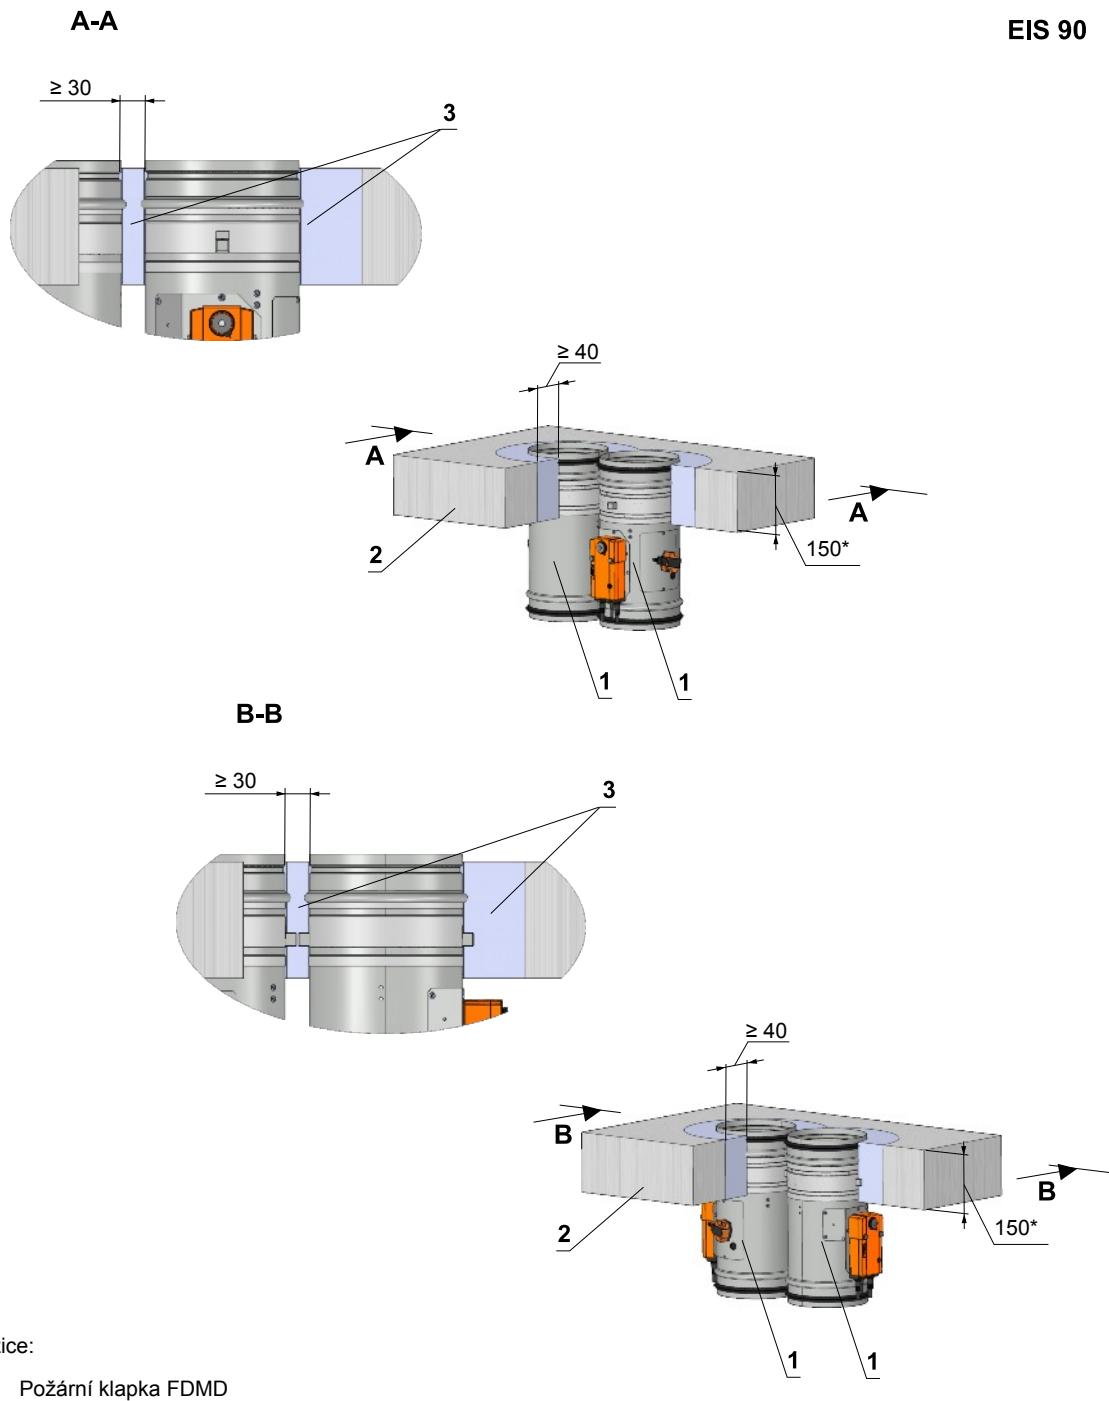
Tuhá stropní konstrukce - sádra nebo malta
